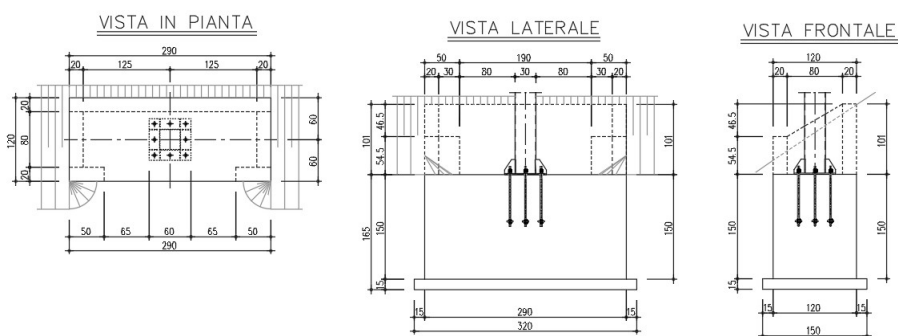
Tipologia della fondazione prevista per il monopalo di tipo B
